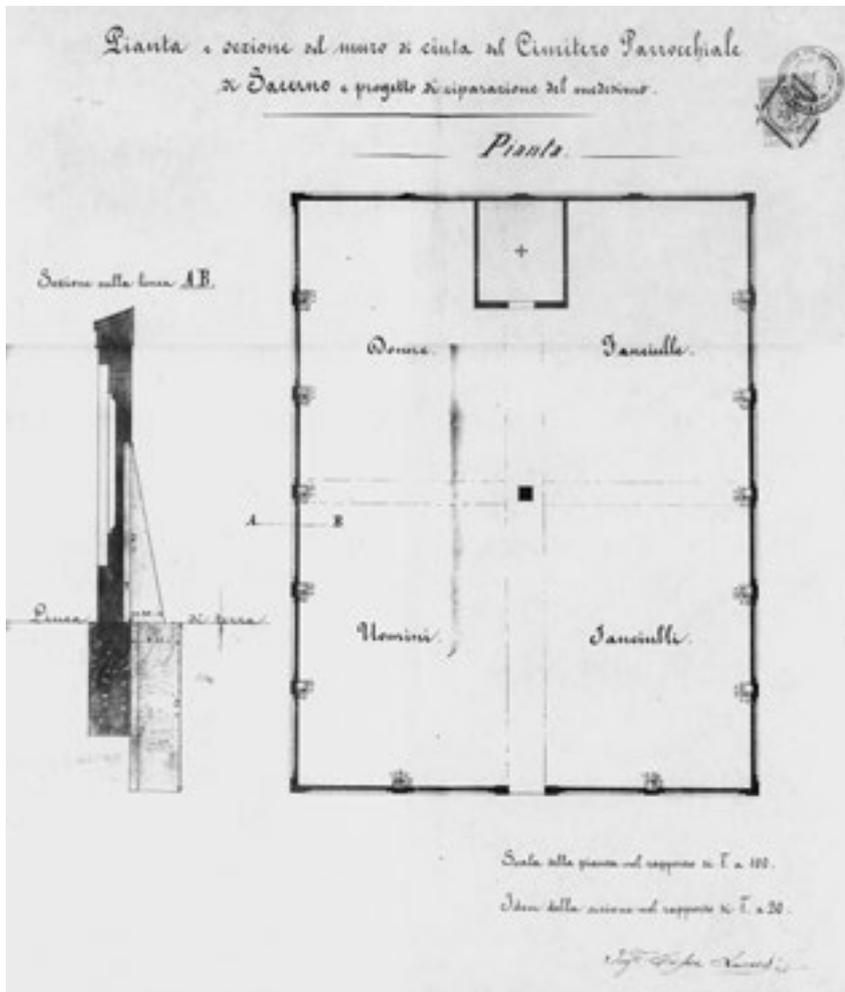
C2 - Pianta e sezione del muro di cinta del Cimitero Parrocchiale di Sacerno, con accanto disegnata la sezione del muro e delle fondamenta (ACC. Atti e Scritture del Segretario, 1856-1939, b. 6).
